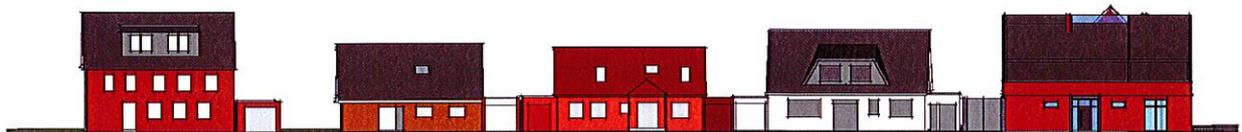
Höhenlage aus Sicht Stapeler Straße
